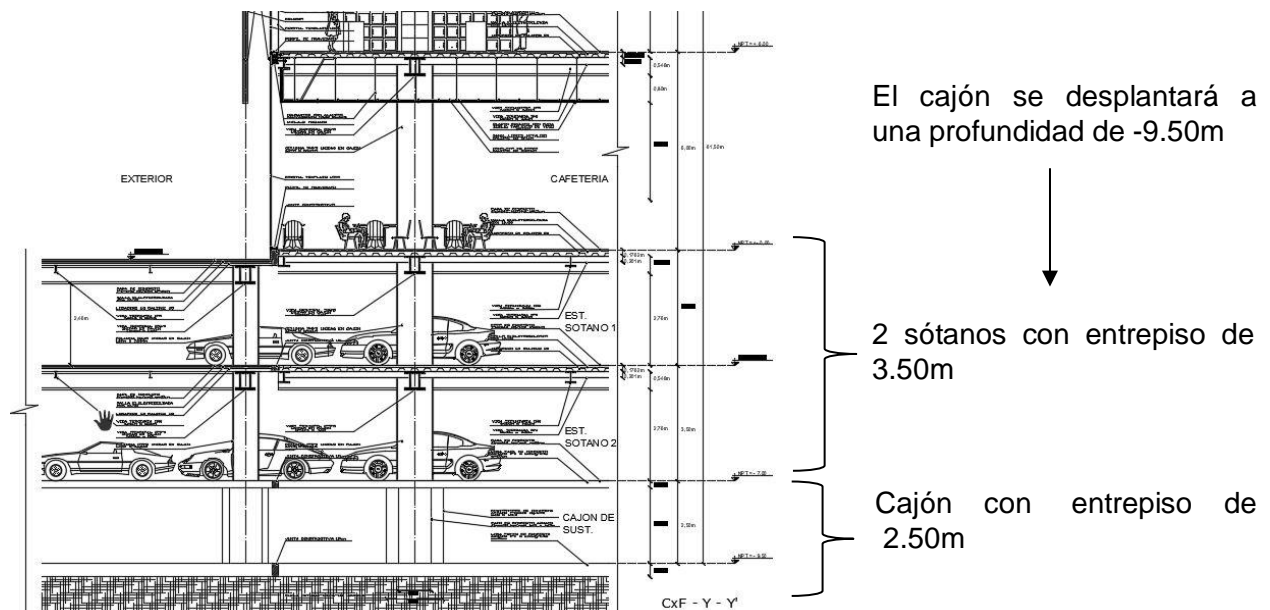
Corte por fachada del proyecto. Elaboración propia.
